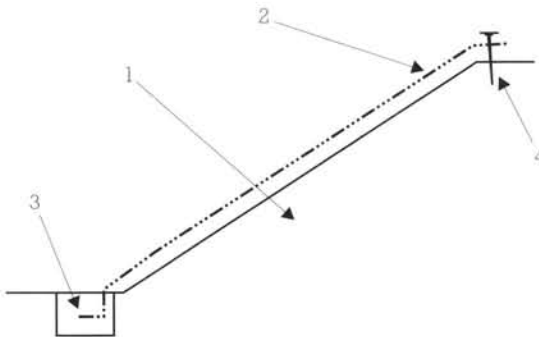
Schéma de principe d'une protection de barrage par un grillage.
